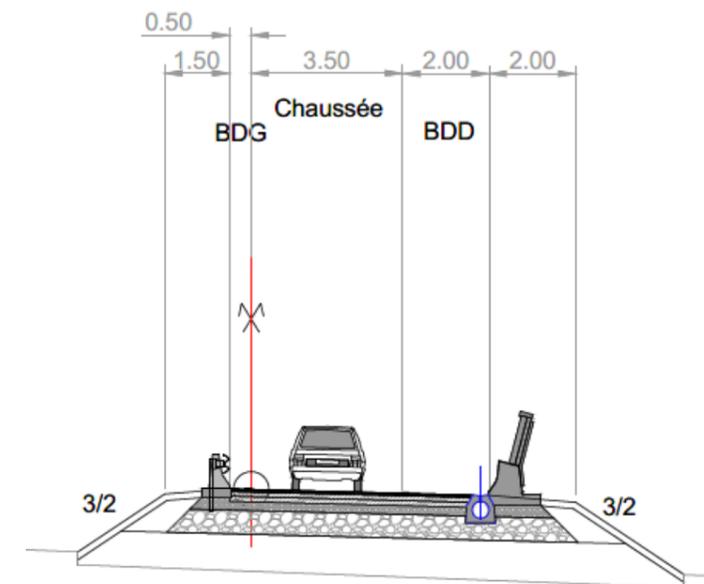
Profil en travers type d'une bretelle unidirectionnelle avec écran acoustique (bretelles de l'échangeur M952)
